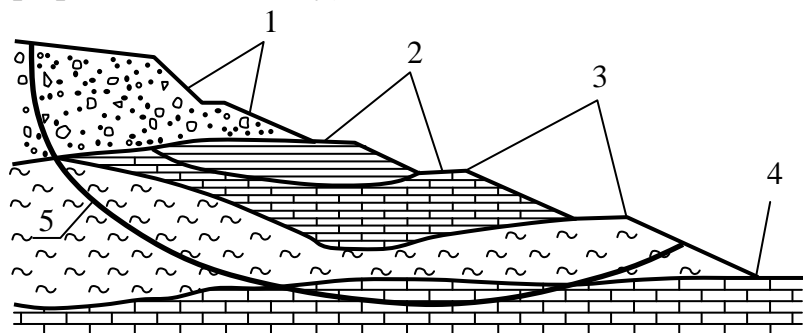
Схема ґрунтового укоса та його основних частин: 1 – уступ; 2 – берма; 3 – бровка уступу; 4 – подошва укосу; 5 – поверхня ковзання
